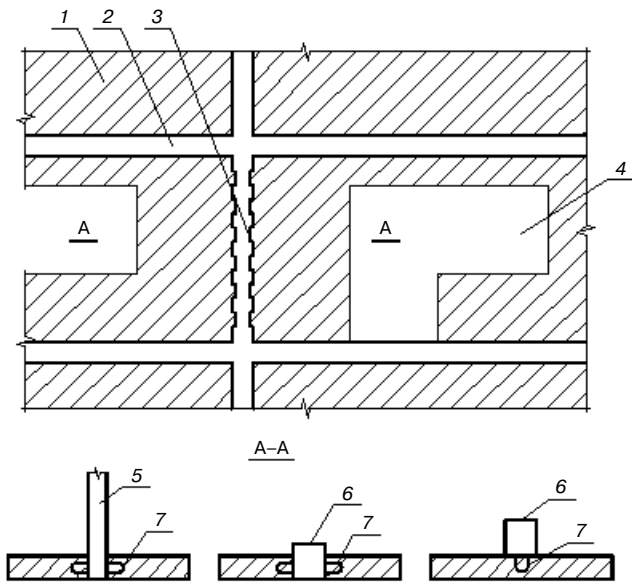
Схемы соединения каменного заполнения с железобетонным каркасом: 1 – каменное заполнение; 2 – монолитное перекрытие; 3 – шпонки; 4 – оконные и дверные проемы; 5 – поперечная железобетонная перегородка; 6 – железобетонная колонна; 7 – анкерные петли
